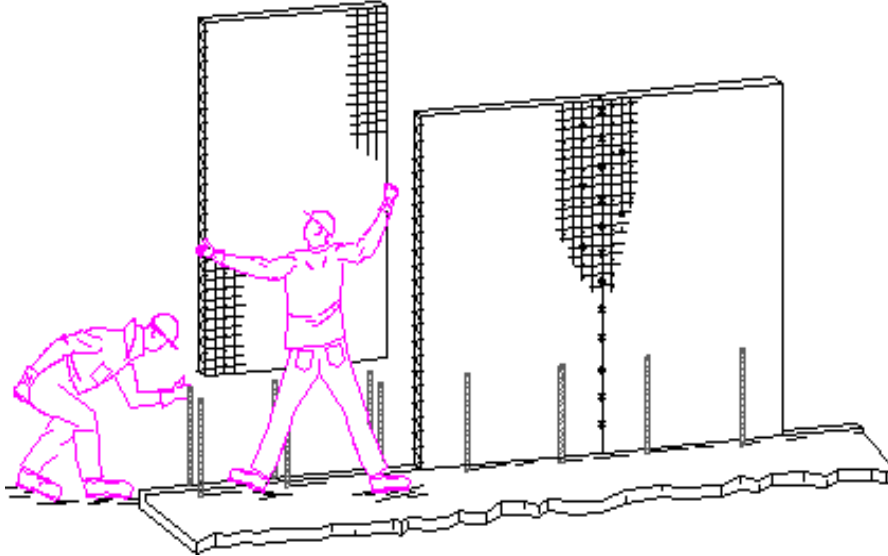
Montaje de panel Covintec y fijación mediante grapas.
